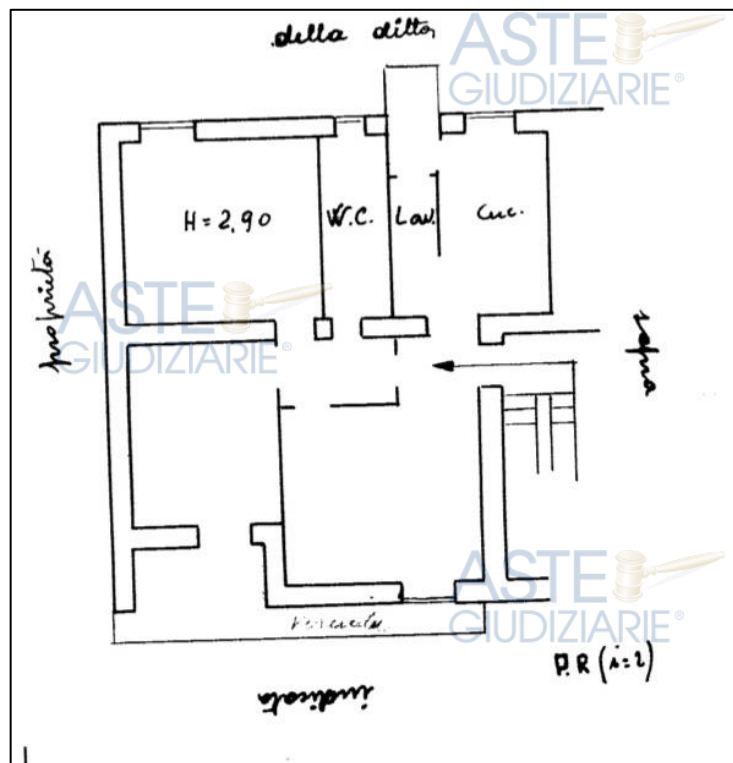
Planimetria agli atti del C.F. dal 01/07/1955.
